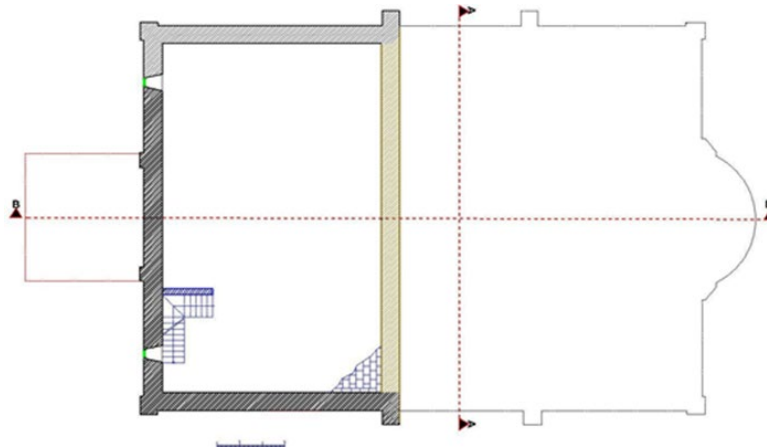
Elazığ Ermeni Protestan Kilisesi Niş Plan-Kesit ve Cephe Detayları (Ş. Öztürk)
